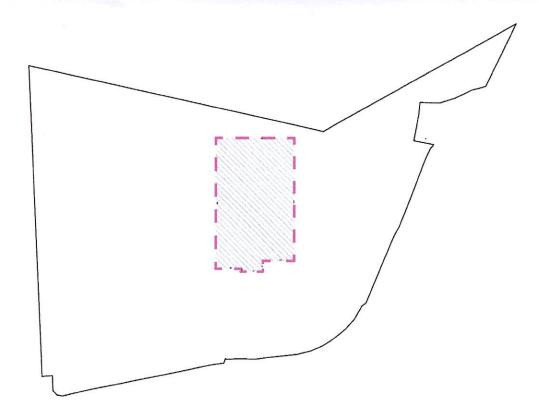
Planta de implantação. Fonte: Plano Engenharia, 2024.
